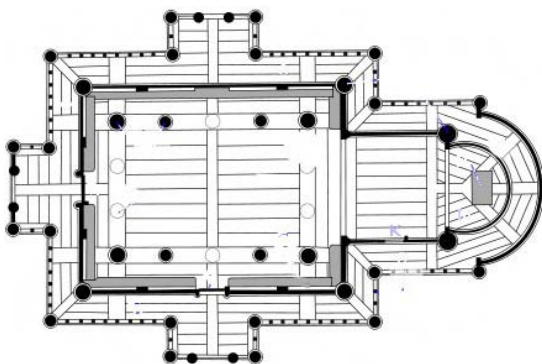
Grundriss der Stabkirche von Borgund
